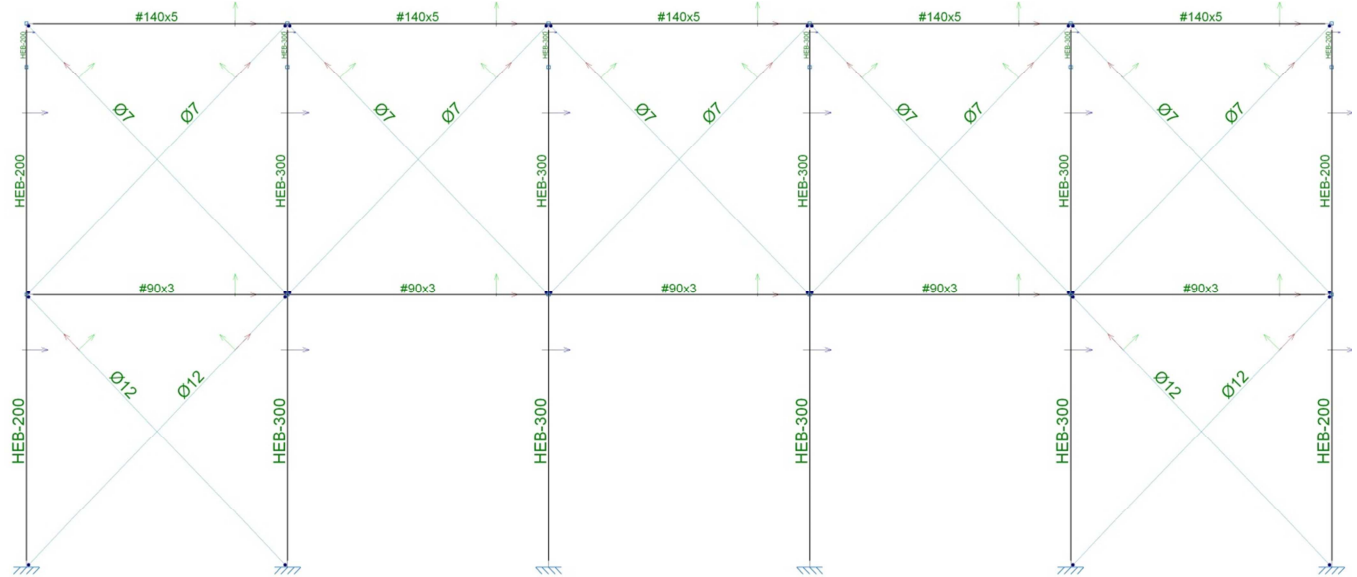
Alzado lateral de pórtico de celosía con tirantes en fachada
